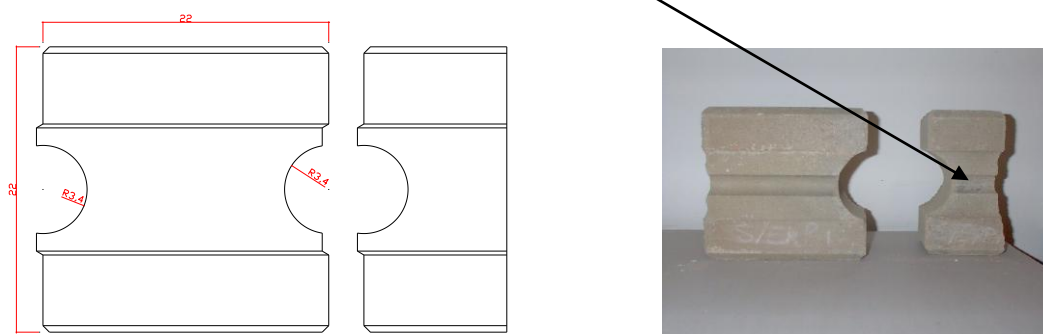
Bloco Padrão Modificado (Em Planta)
